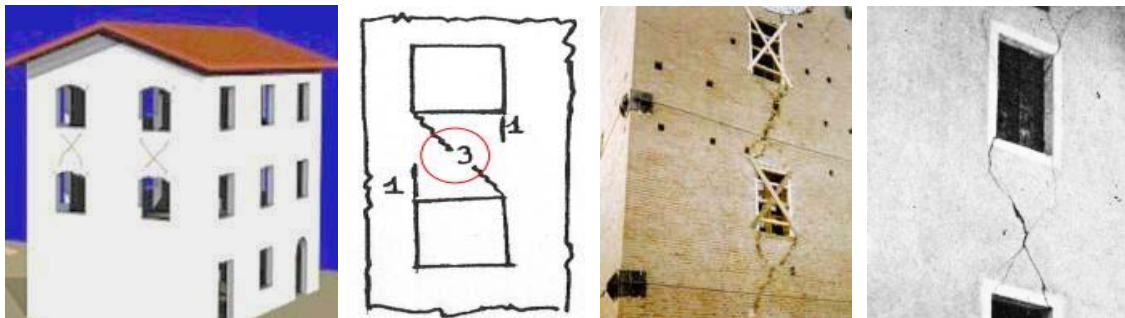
Rottura dei pannelli di fascia per taglio
